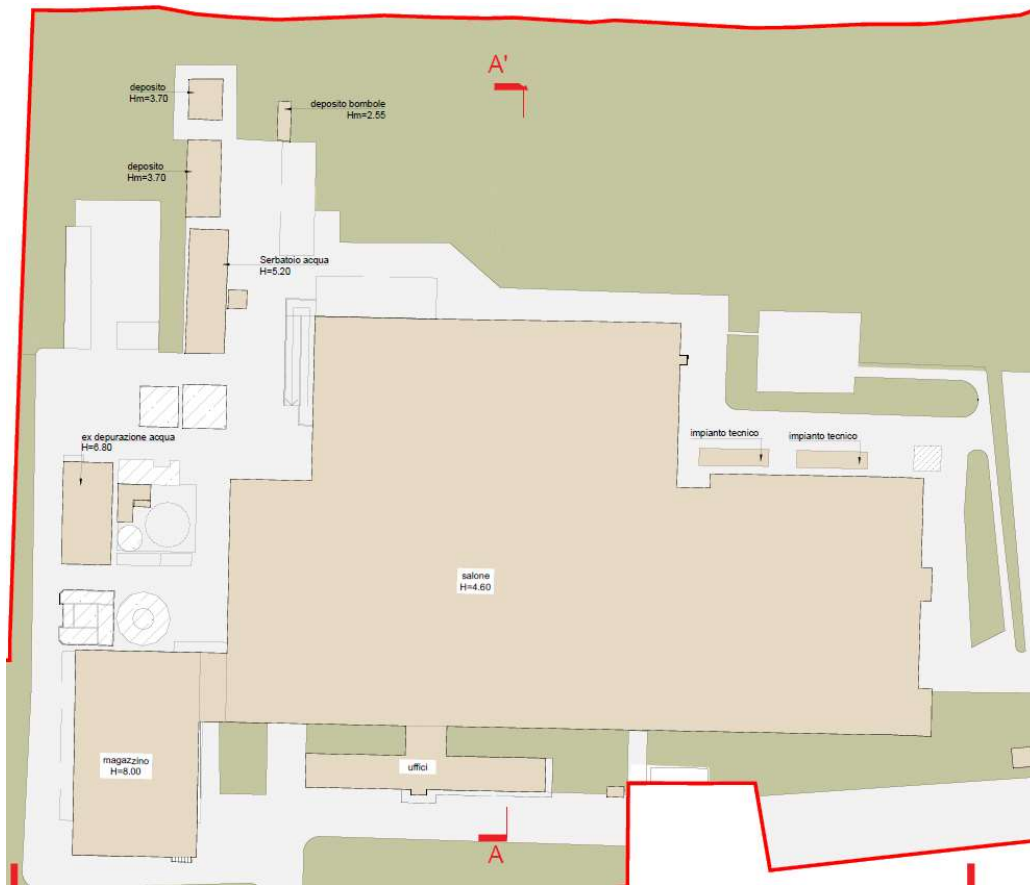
Planimetria del piano terra (stralcio del doc. [11])
